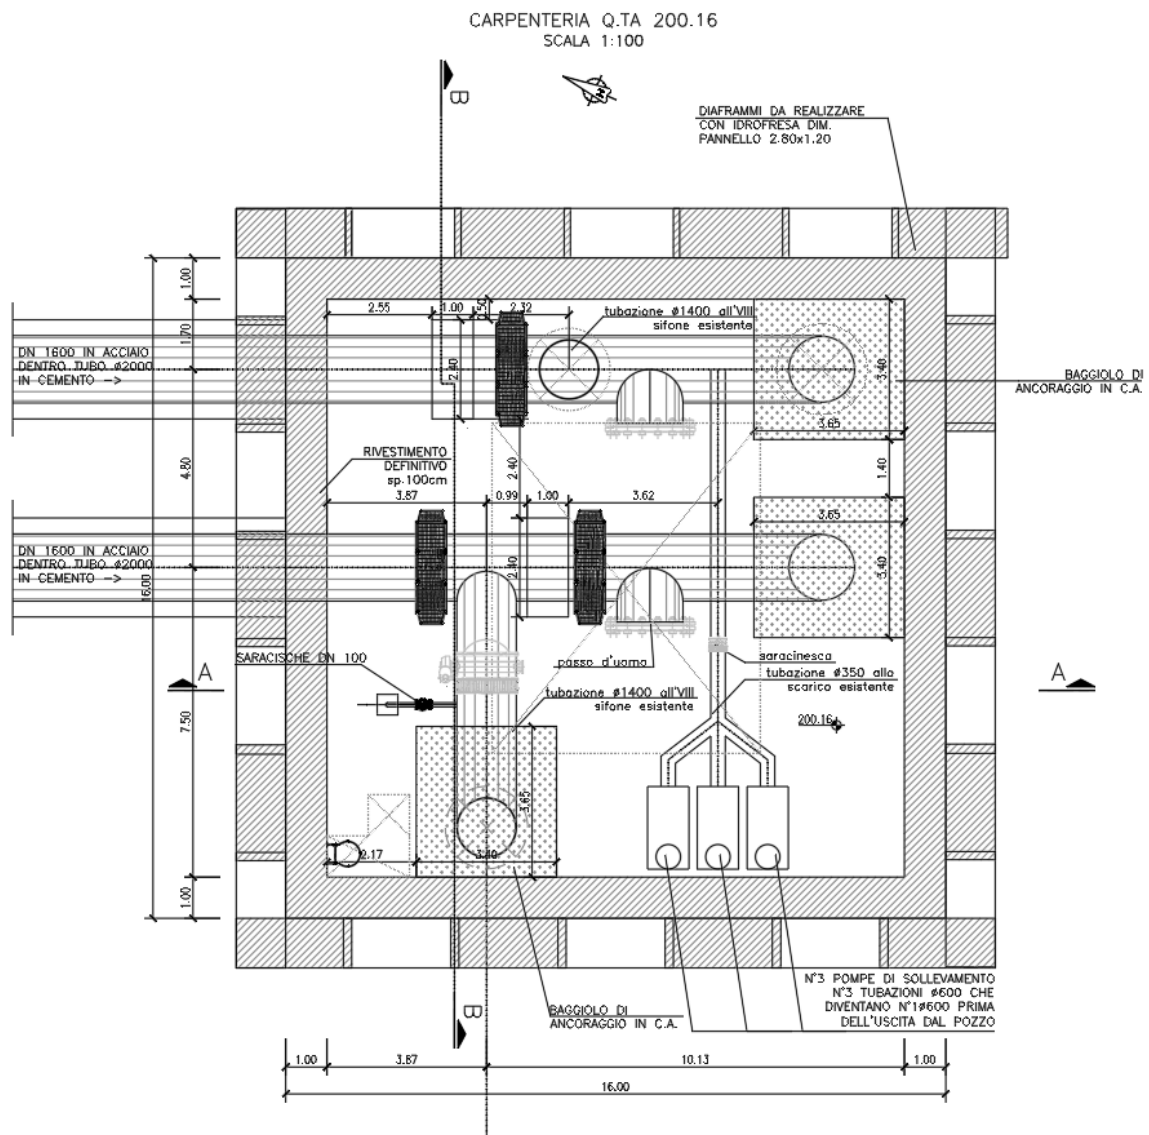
Rappresentazione in pianta del manufatto PZ4
